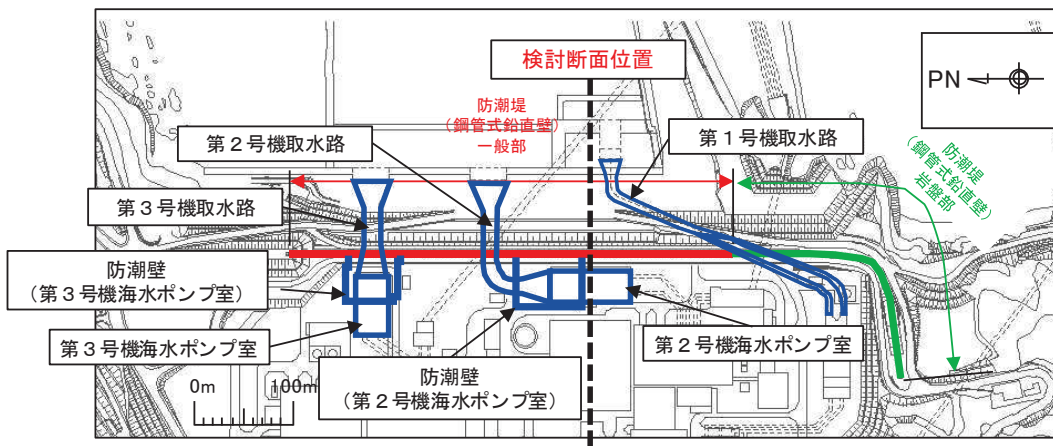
鋼管式鉛直壁（一般部）と隣接する構造物位置
